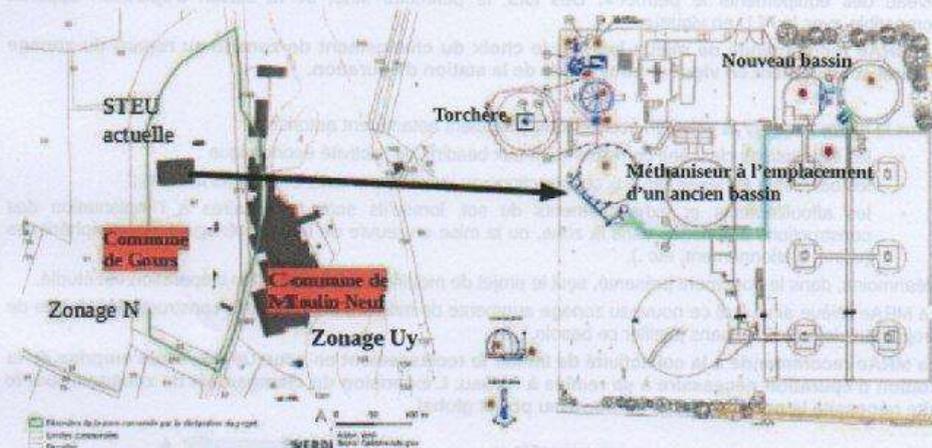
Extrait du plan cadastral et plan de masse du projet retenu (Source : notice explicative, pages 25 et 176)
